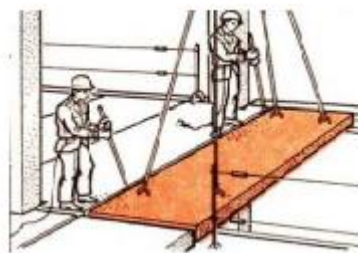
Наведение, ориентирование и установка плит перекрытия
